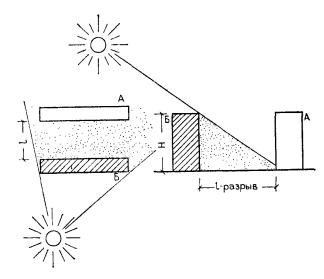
Схема санитарных разрывов между жилыми эданиями. План, разрез
